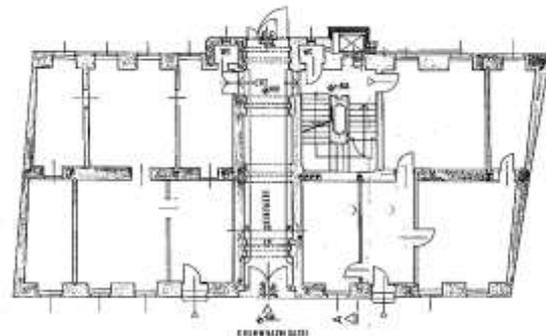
Grundriss Krummbaumgasse 12
